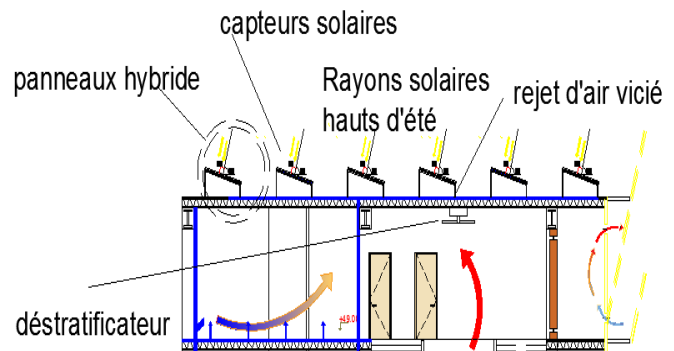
Zoom sur les panneaux et planchers réversibles coupe AA
